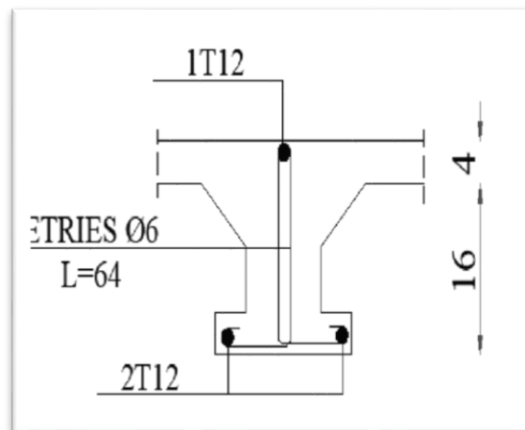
schéma ferrailage de plancher. terrasse inaccessible
